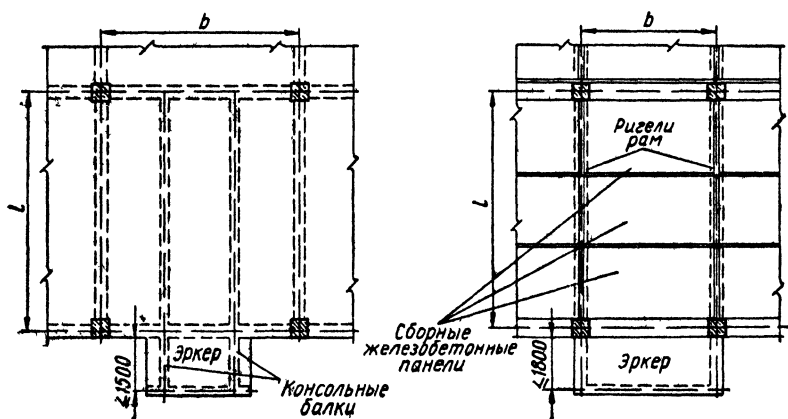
Схемы железобетонных балок эркера в плане.
